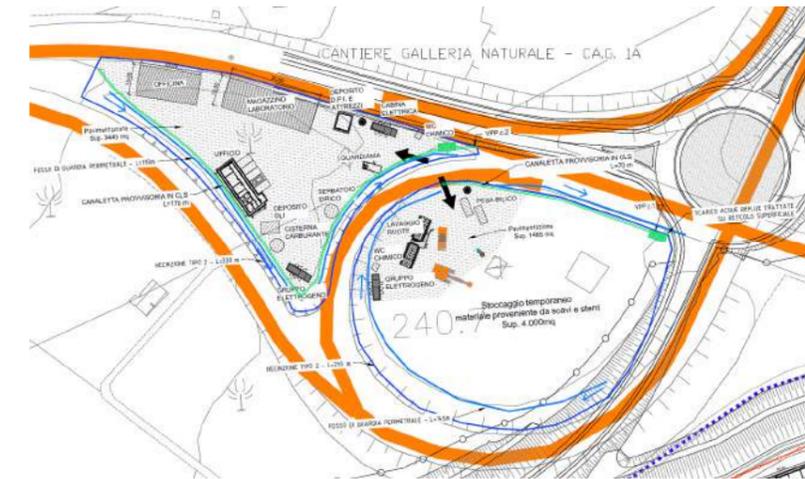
Planimetria del cantiere operativo CA.G.1A.
